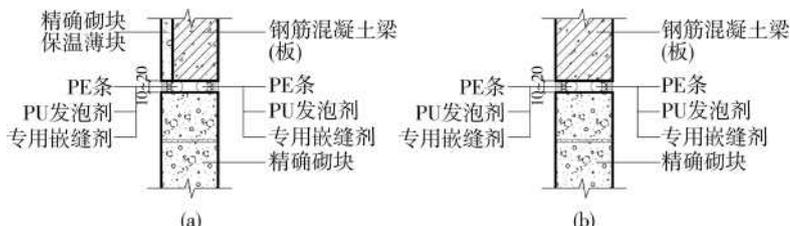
砌块墙体顶部与钢筋混凝土梁、板交接处柔性连接构造
